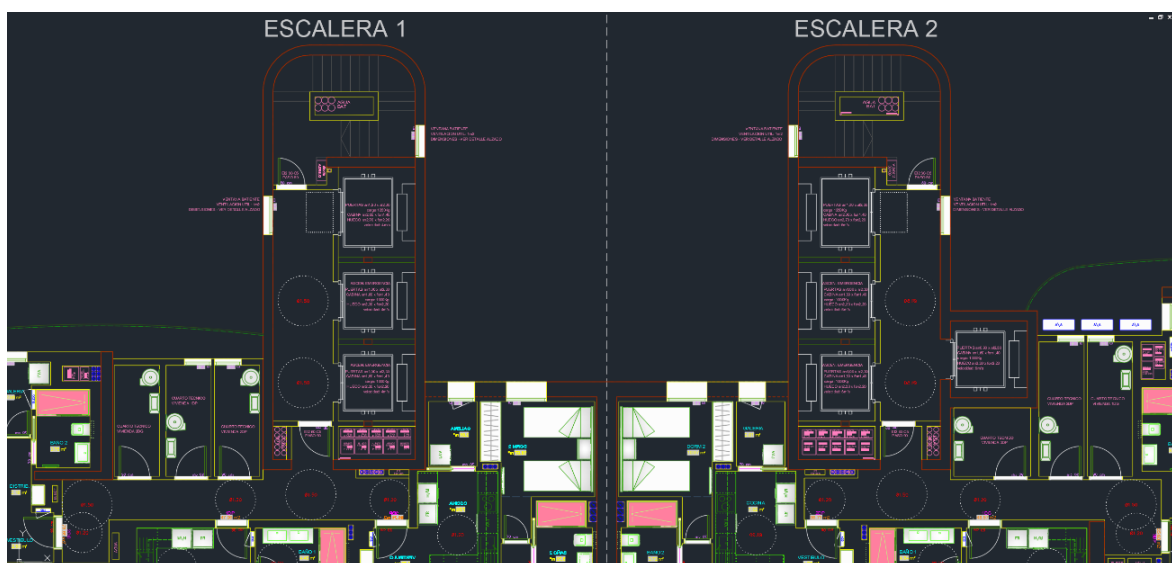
Detalle definición planta tipo Anteproyecto
